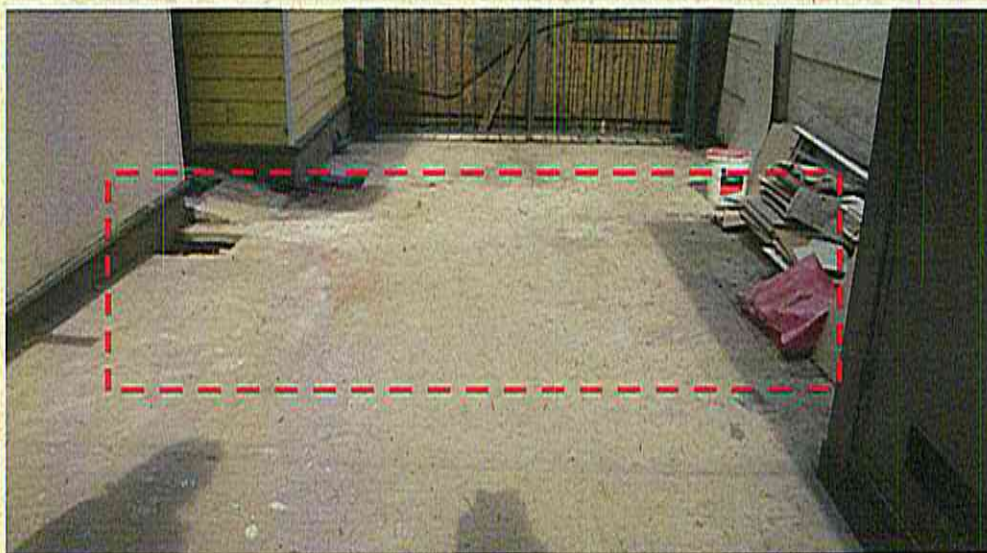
C.11.1 y C.11.2 Canales y Bajadas, Construcción sala cuna y jardín
